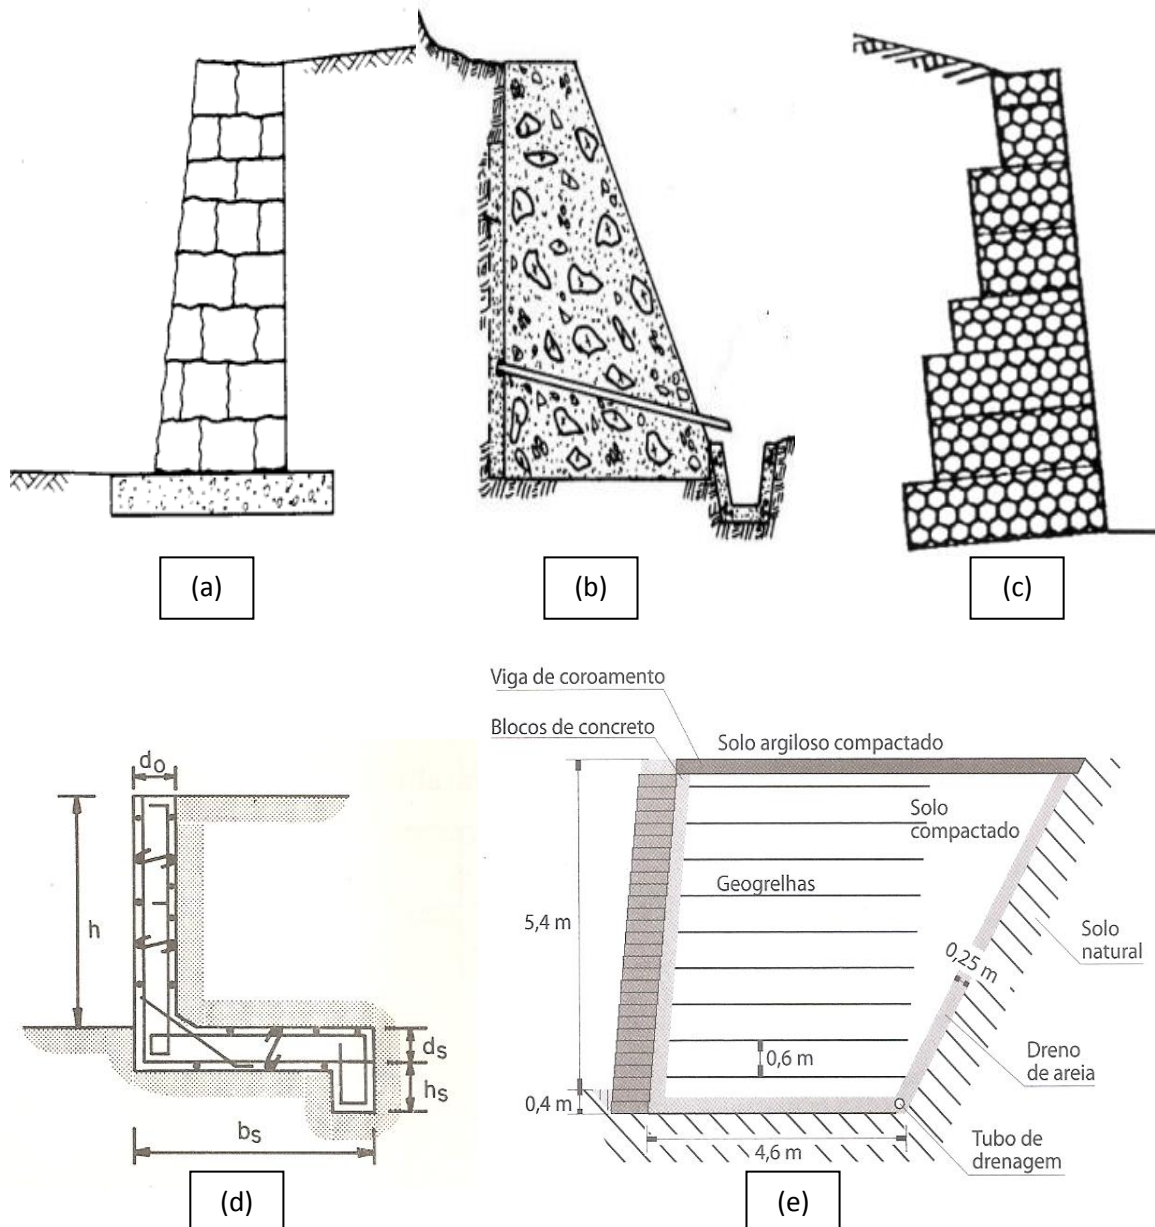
Exemplos de muros – a) Muro de Gravidade em Pedra, b) Muro de gravidade em Concreto Ciclópico, c) Muro de gravidade em Gabião, d) Muro de concreto armado em 'L' (MOLITERNO, 1980), e) Muro de Solo reforçado (EHRlich e BECKER, 2009)
